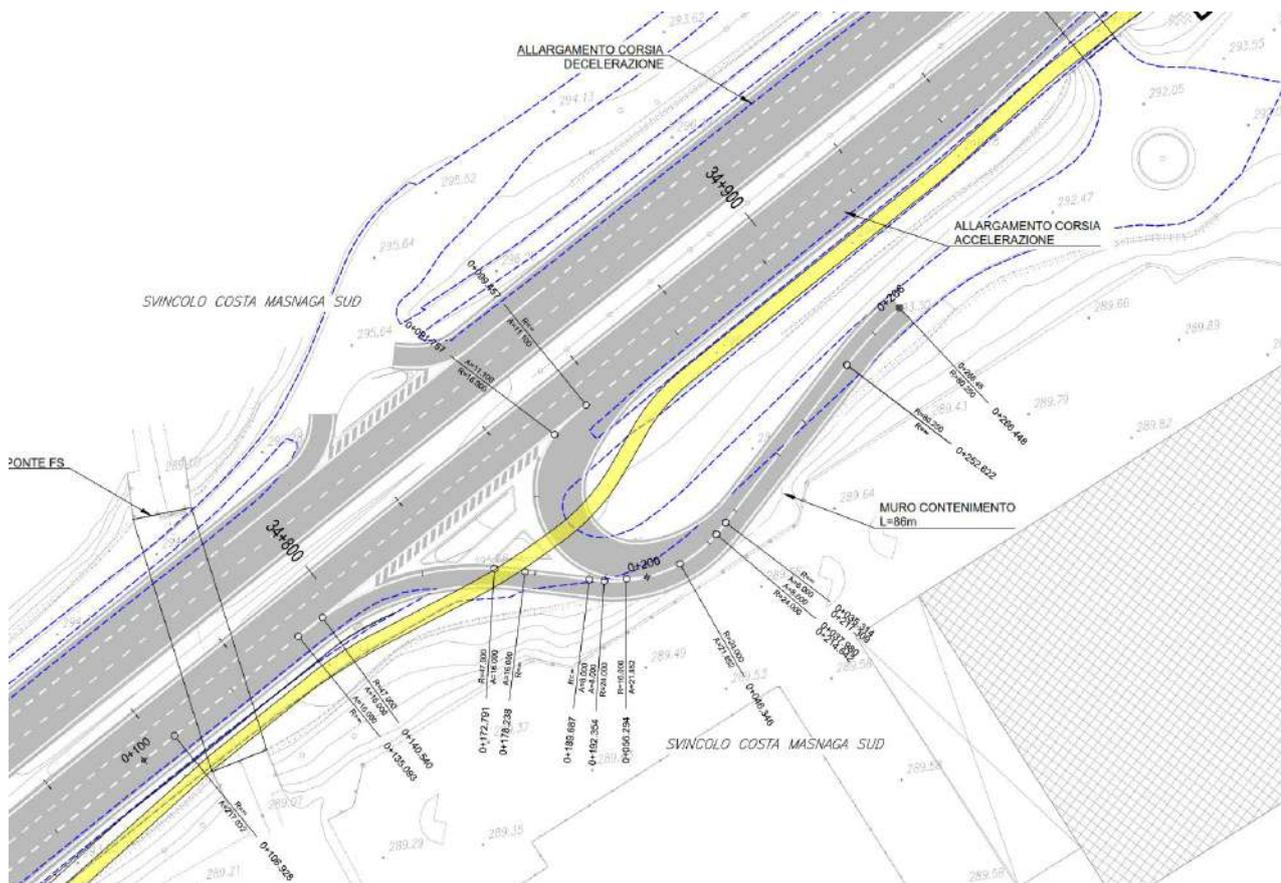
stralcio planimetria di progetto rampa di immissione di Costa Masnaga Sud
